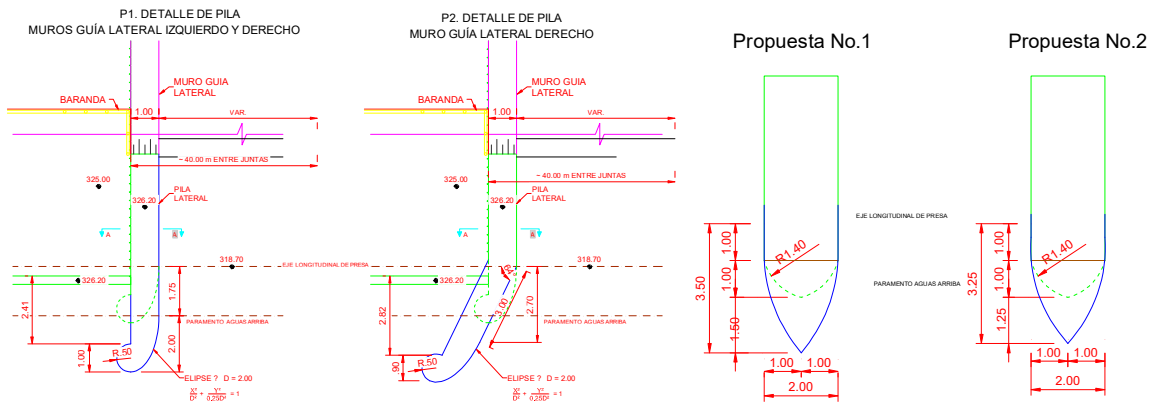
Vista en planta de la geometría de modificación de pilas laterales y centrales propuestas para la serie 5.
